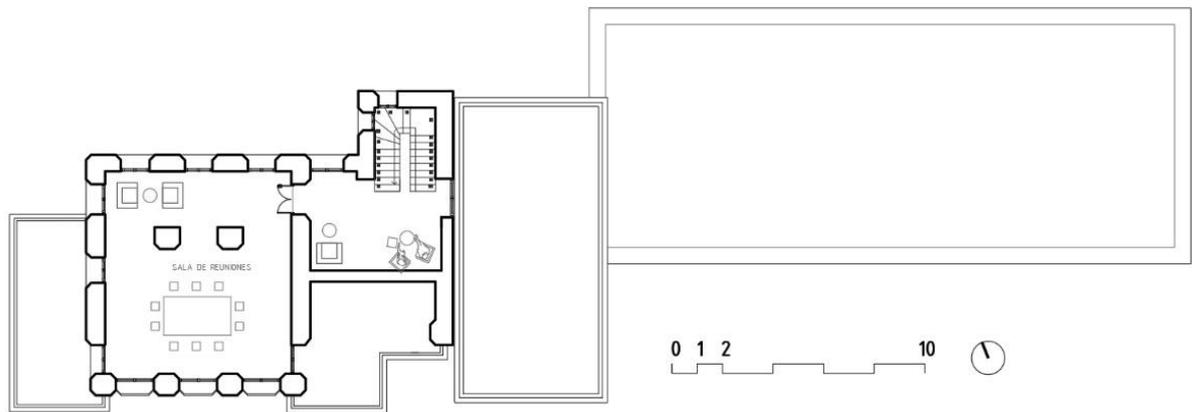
Hipótesis del Sanatorio de Cesuras, planta segunda. Elaboración propia
